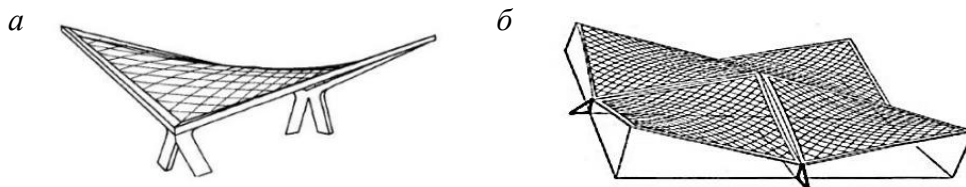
Вантовая сеть на замкнутом жестком контуре на круглом/овальном плане
